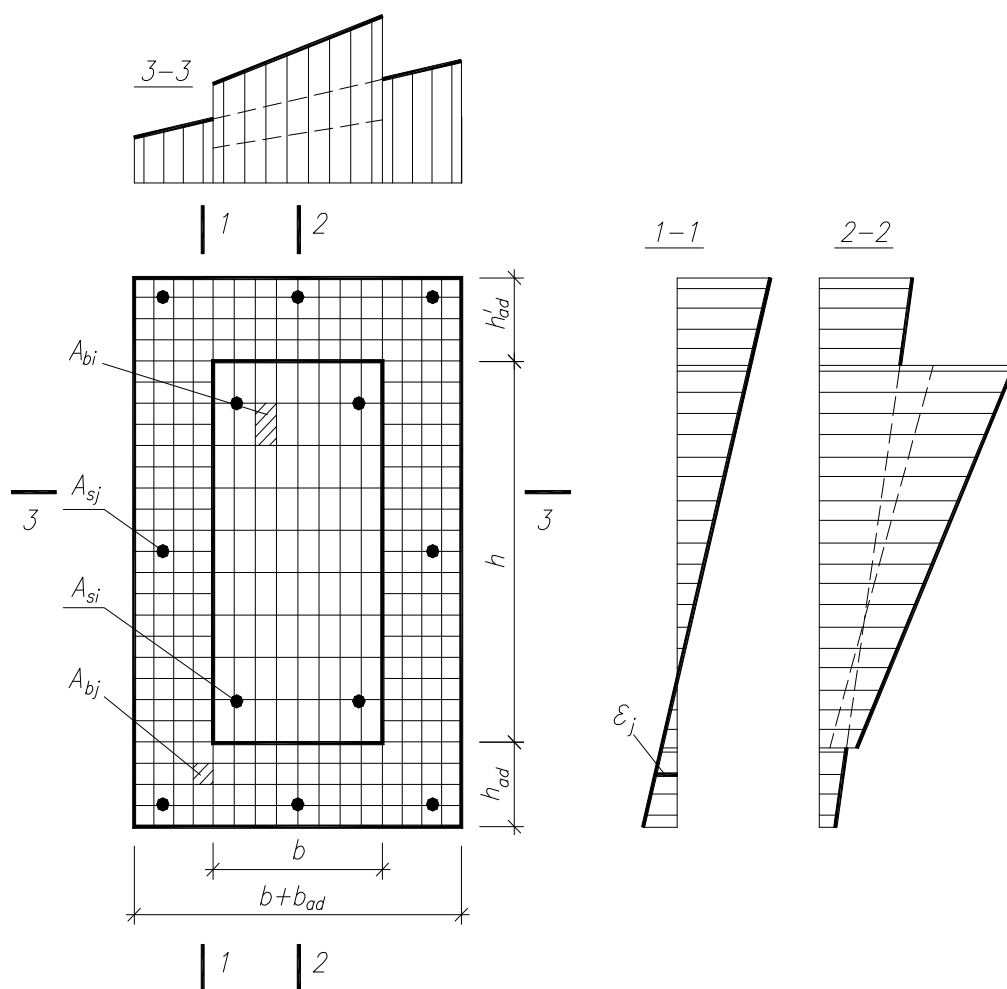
Расчетная схема косоугольного железобетонного элемента, усиленного ободом
